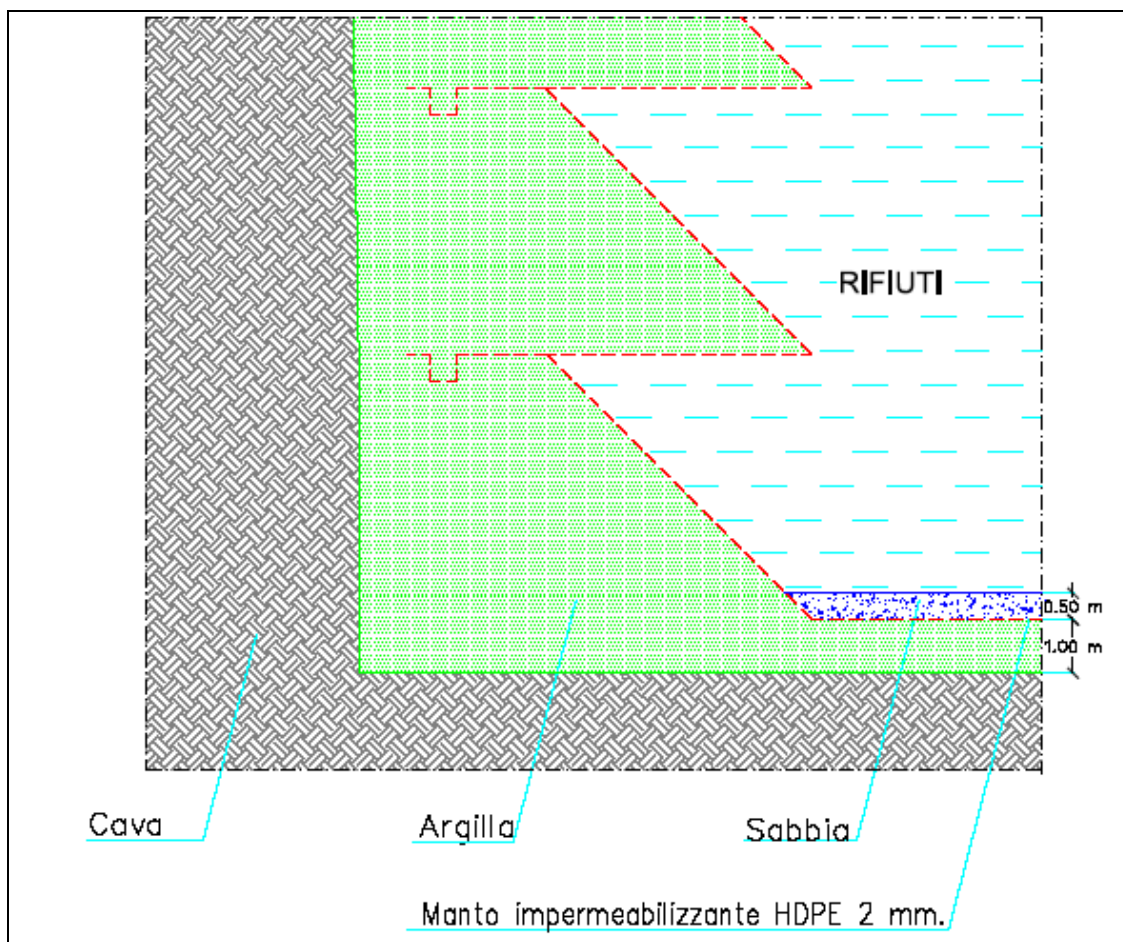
Schema tipo di impermeabilizzazione delle pareti della discarica e del fondo.
